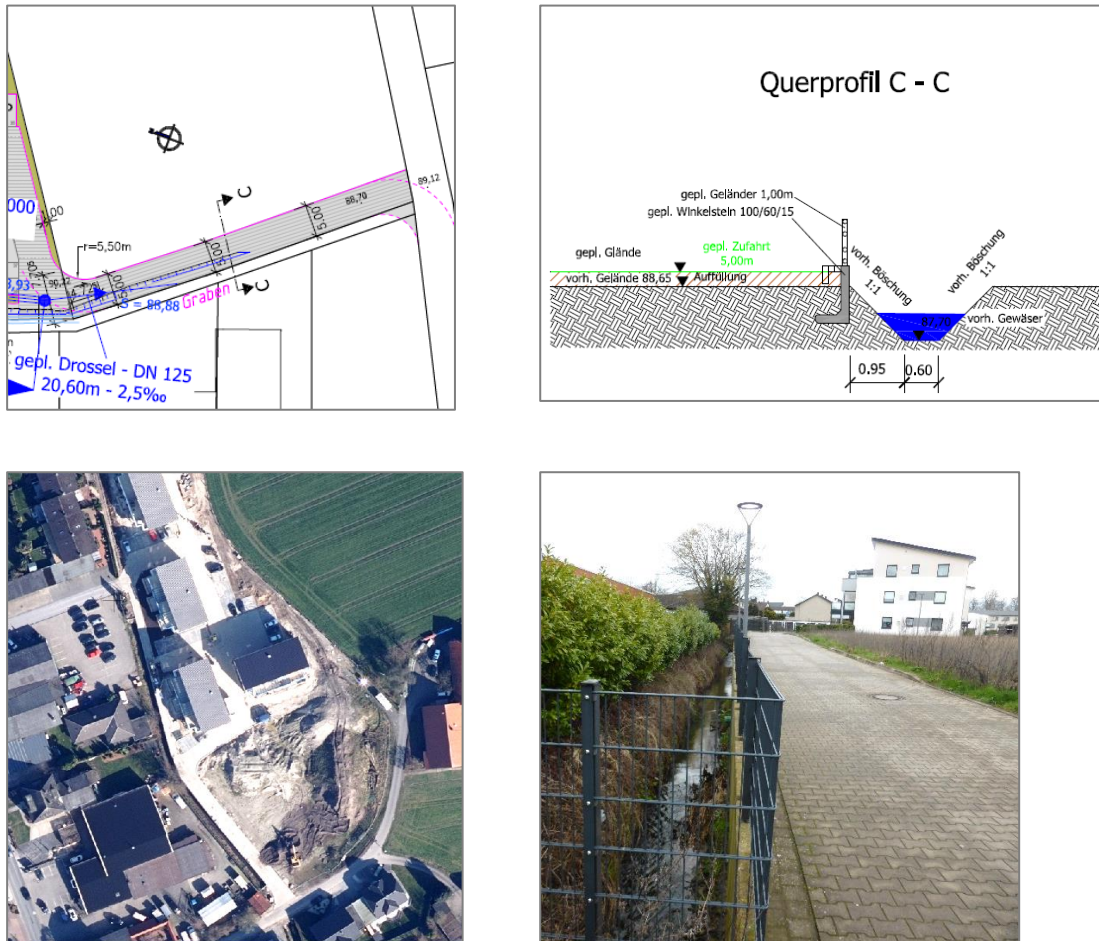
Oben: Lageplan und Querprofil C-C zur Herstellung der privaten Erschließungsstraße (INGENIEURBÜRO J. BERGEMANN GMBH 2014),
